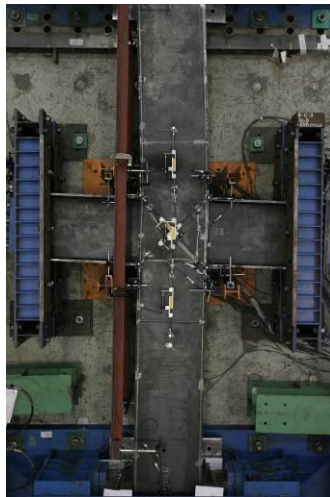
破壊状況(試験体 B-A-8)
